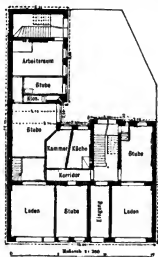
Grundriss eines städtischen Wohnhauses.
